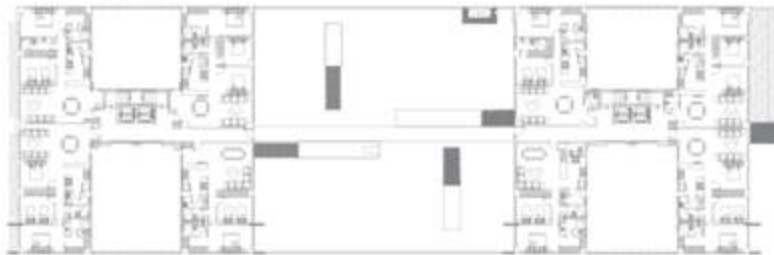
Planta baja esquemática de conjunto, proyecto Wind Universidad.
